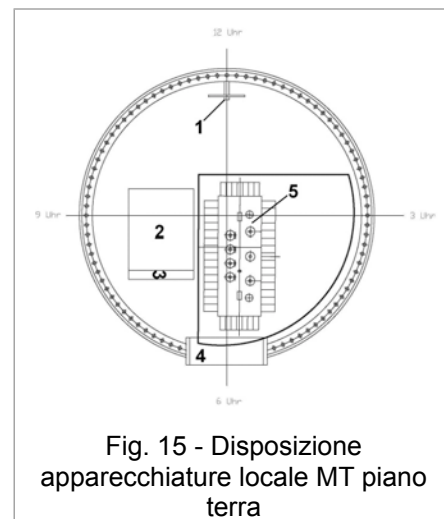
Disposizione apparecchiature locale MT piano terra
